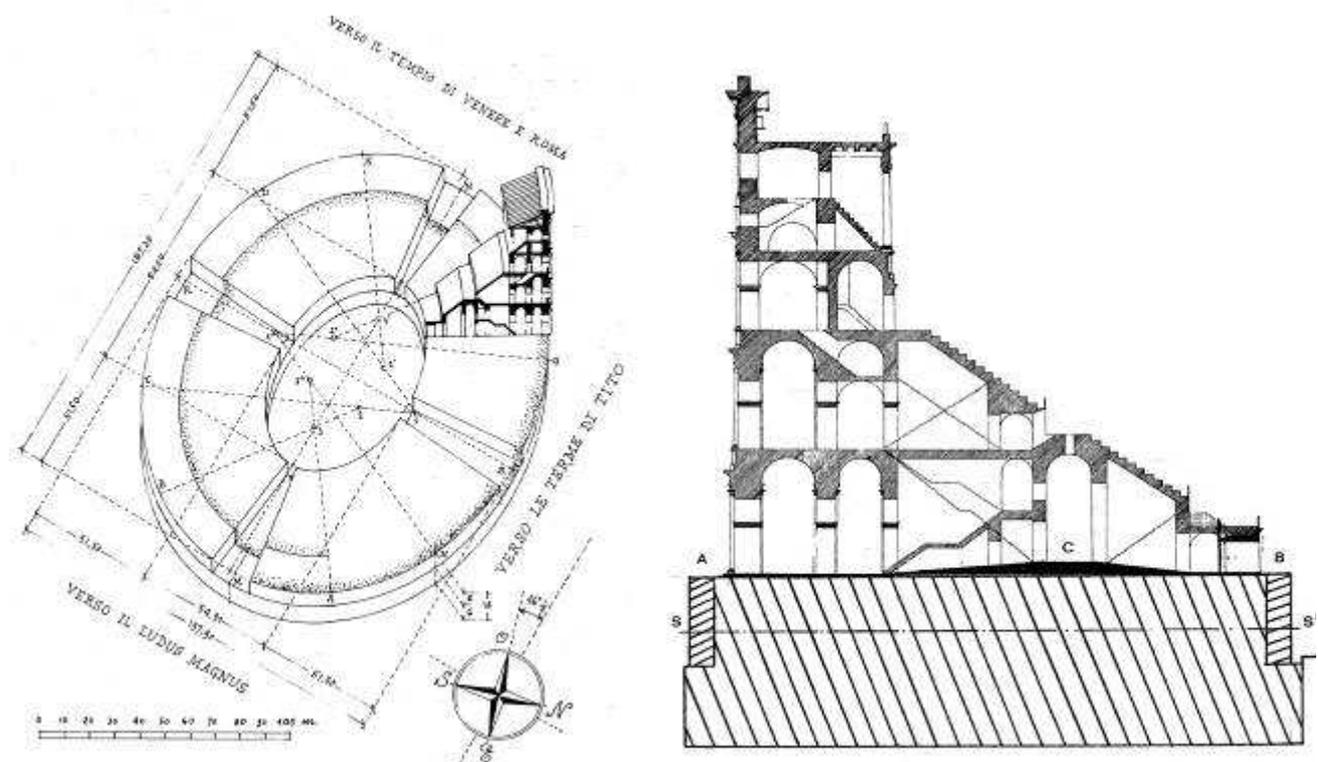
Roma. Anfiteatro Flavio. A sinistra: Ricostruzione assonometrica schematica dell'ellisse di fondazione. A destra: Sezione ricostruttiva della fondazione e dell'alzato (MOCCHIEGANI CARPANO 1977, dis. di G. Zander)
